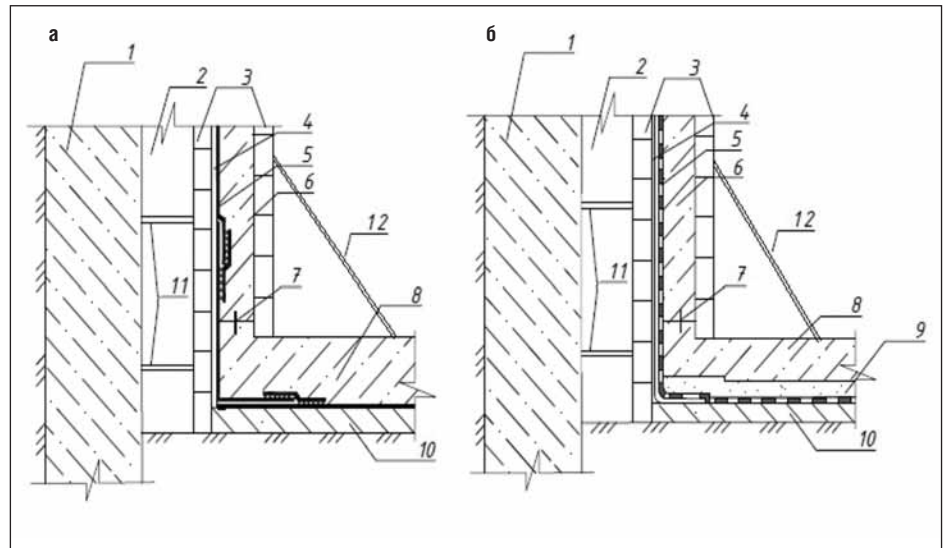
Гидроизоляция конструкций с пазухами для обратной засыпки грунта: а – гидроизоляционное покрытие из рулонов заводского изготовления, б – гидроизоляционное покрытие из напыляемых составов; 1 – ограждение котлована; 2 – пазухи; 3 – внешний и внутренний щит опалубки; 4 – подложка из геотекстильной ткани; 5 – гидроизоляционное покрытие; 6 – монолитная стеновая конструкция; 7 – гидрошпонка; 8 – лотковая плита; 9 – защитный слой гидроизоляции; 10 – бетонная подготовка; 11 – телескопические шпindelи; 12 – рама для одностороннего бетонирования
